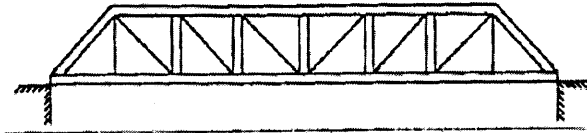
Jembatan tipe rangka kayu (*wooden truss*)
